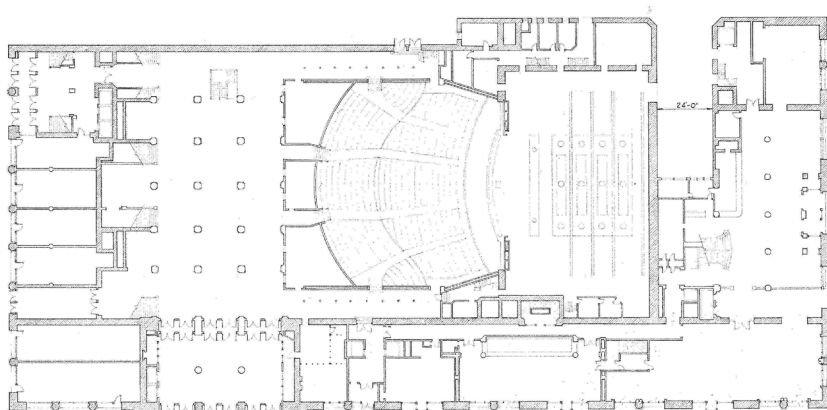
Planta piso térreo Auditorium Building, 1887-89
